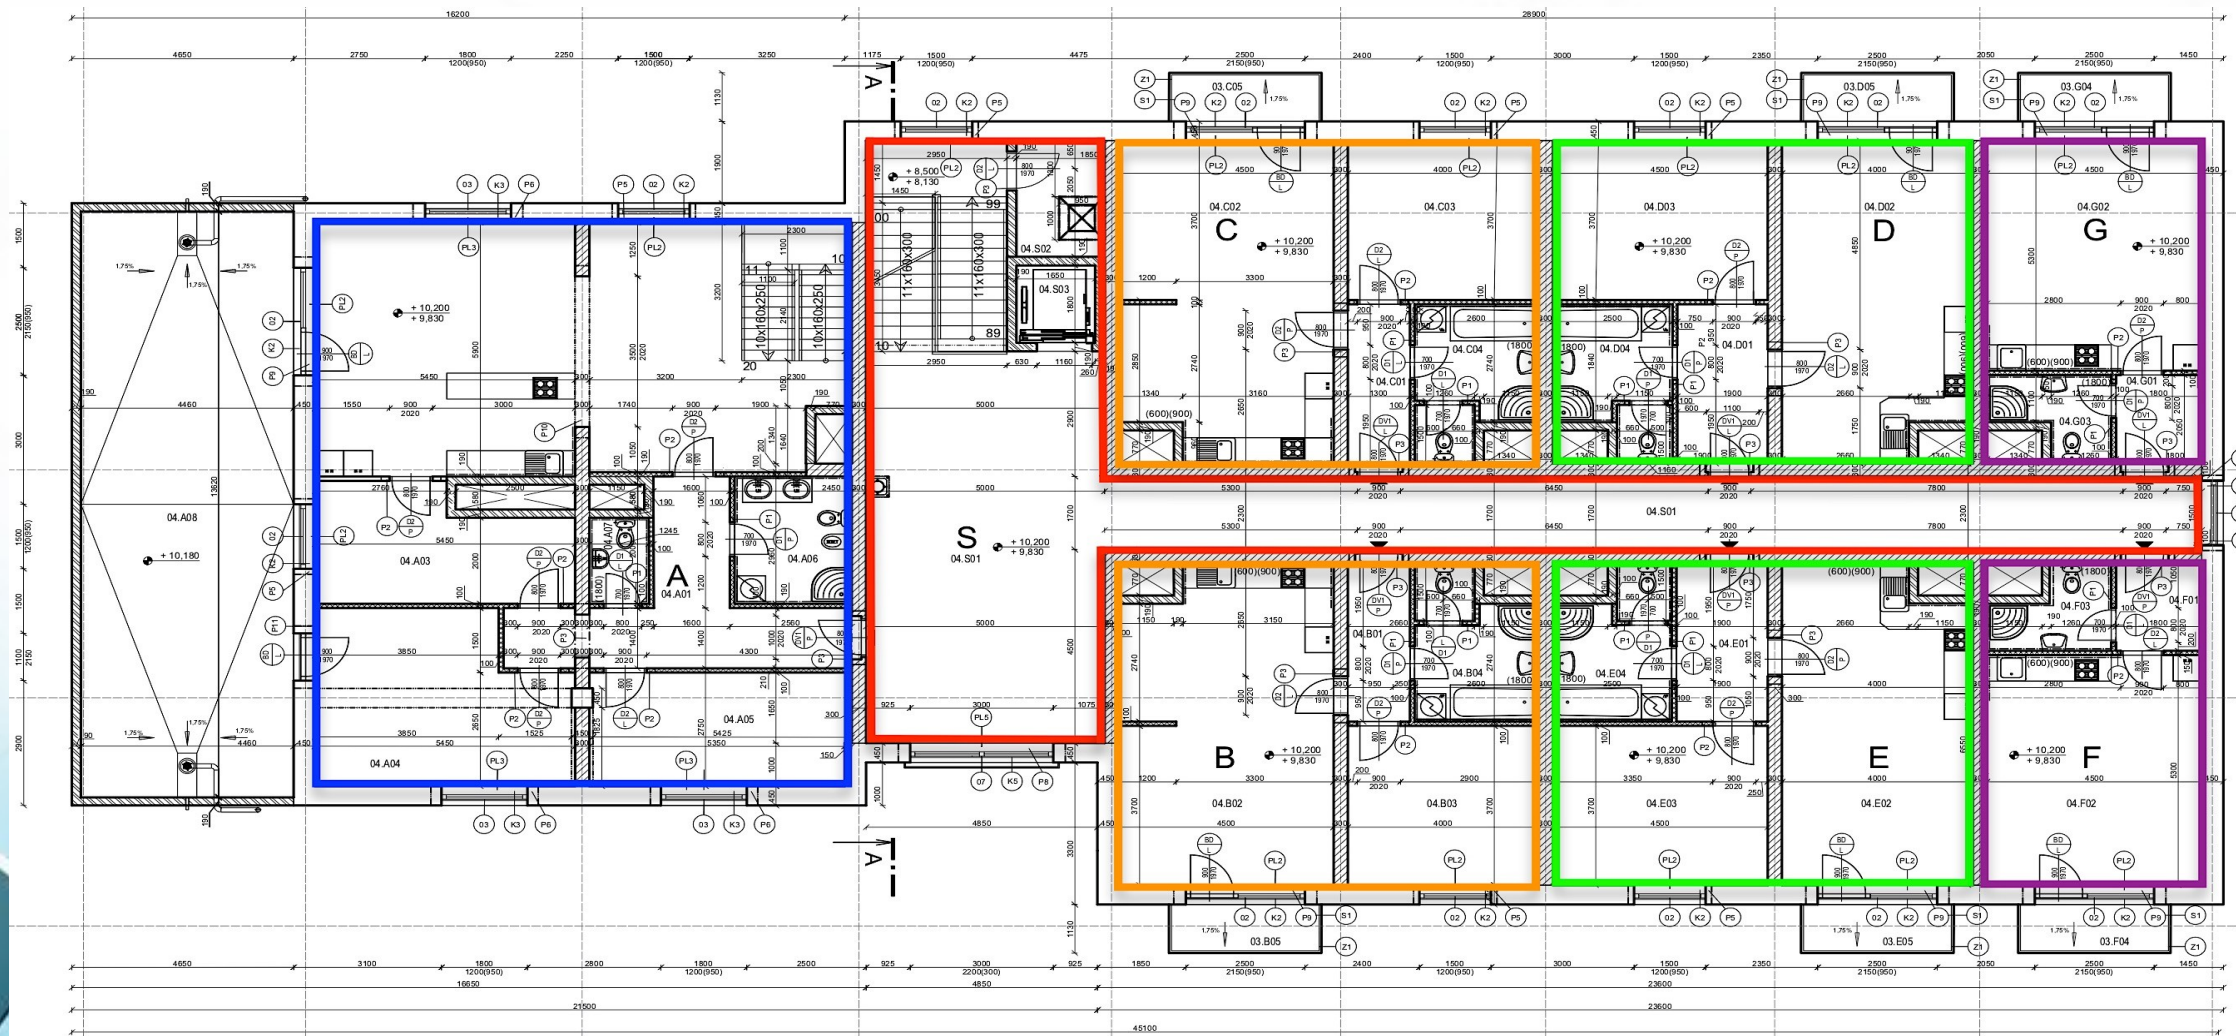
Půdorys 2.NP, zdroj: vlastní
